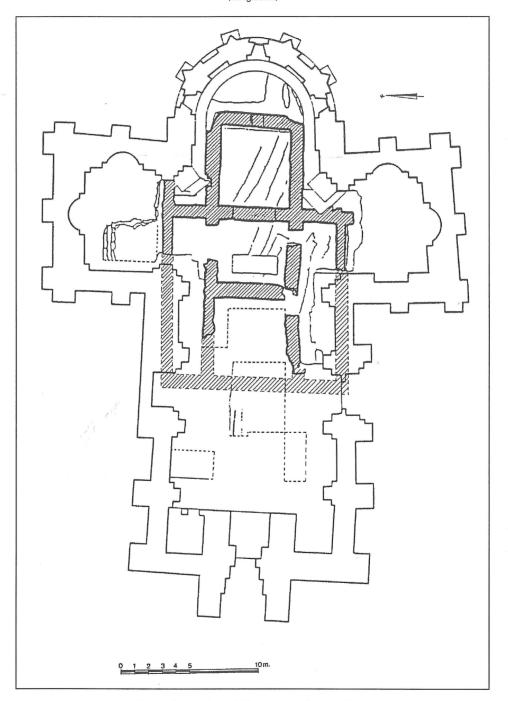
Siresa (Huesca). Planta (según: Puertas Tricas)
